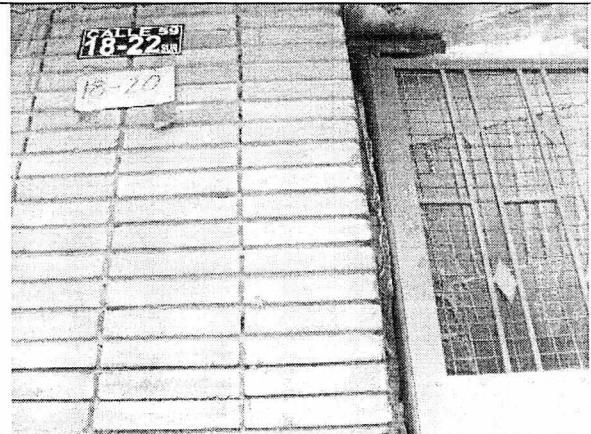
Nomenclatura del predio CL 59 18 -22 Sur
